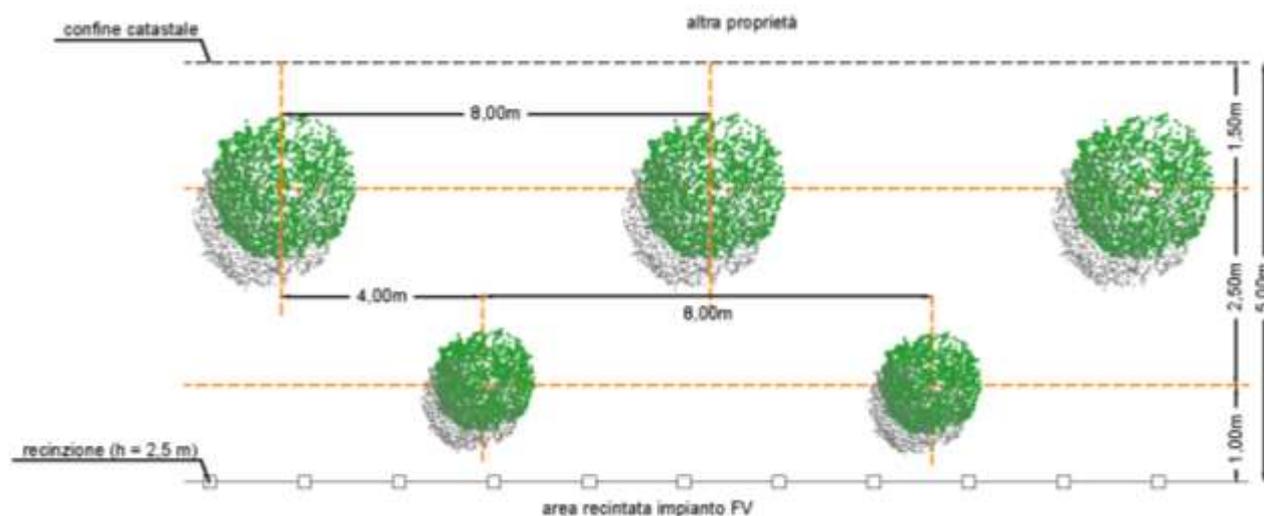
Siepe polispecifica (planimetria di progetto).
